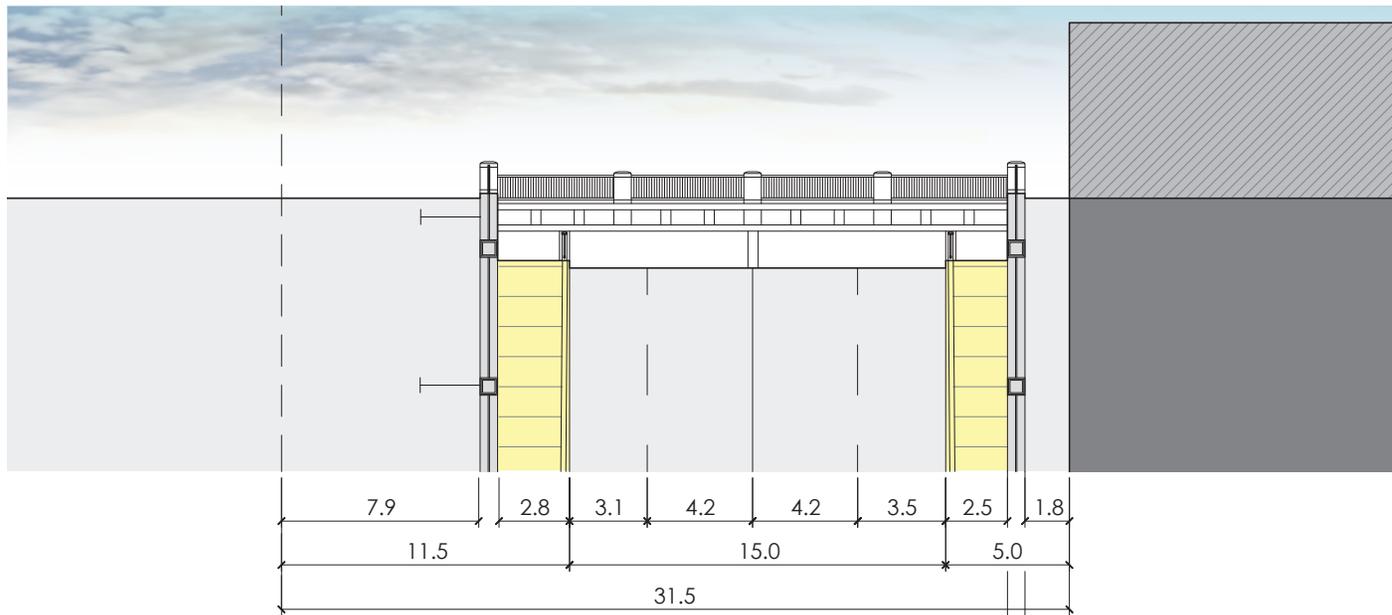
Coupe C1-C1', existant - avenue du Parc, au sud des voies ferrées entre Van Horne et rue Beaubien, échelle 1:300
